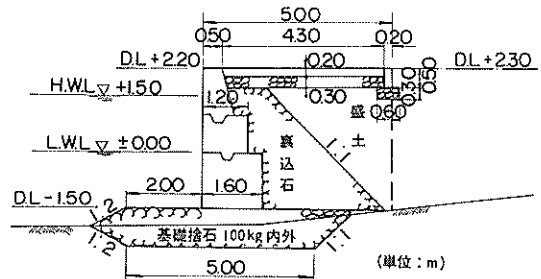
雄勝港大浜物揚場 (-1.5m) 標準断面図
